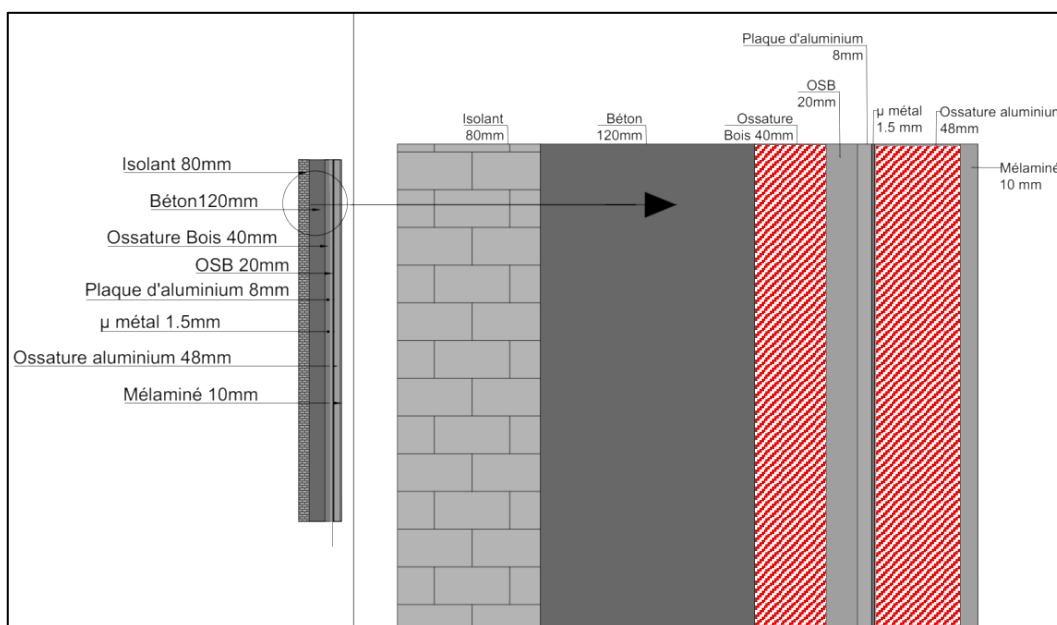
Localisation de panneaux de laine minérale en parois verticales
